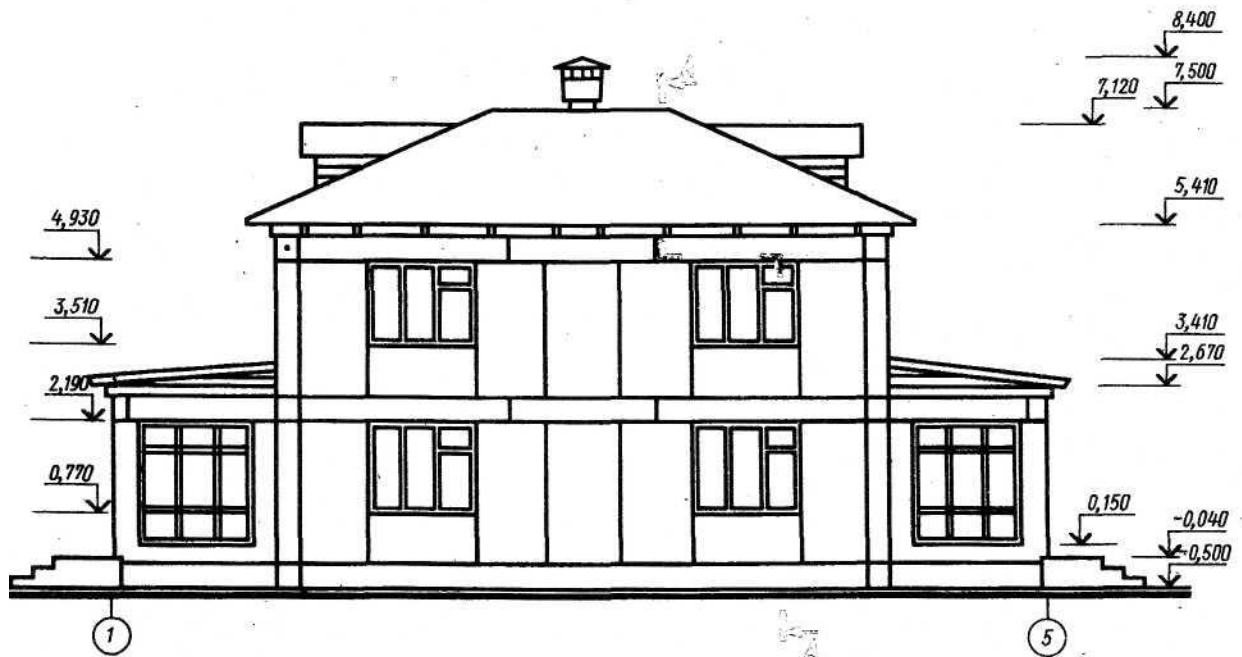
Пример оформления фасада жилого крупноблочного дома
